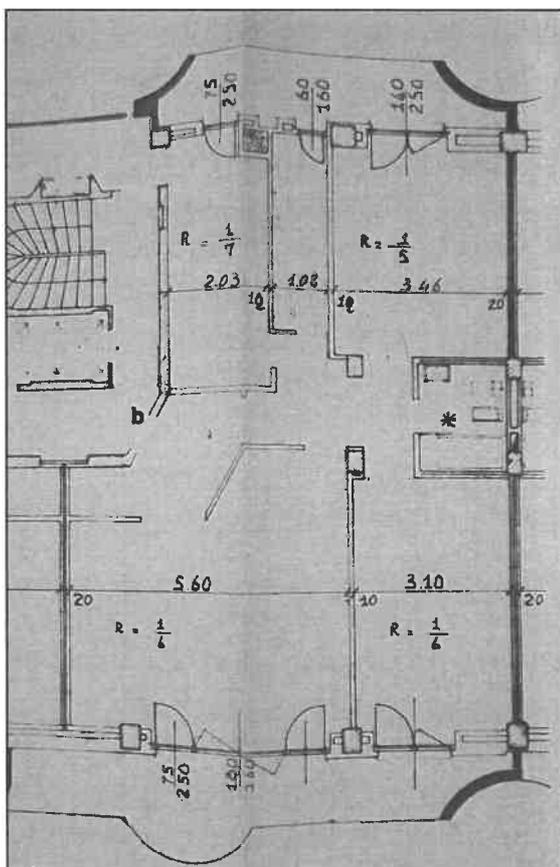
Planimetria allegata al C.E. 25.06.1974
